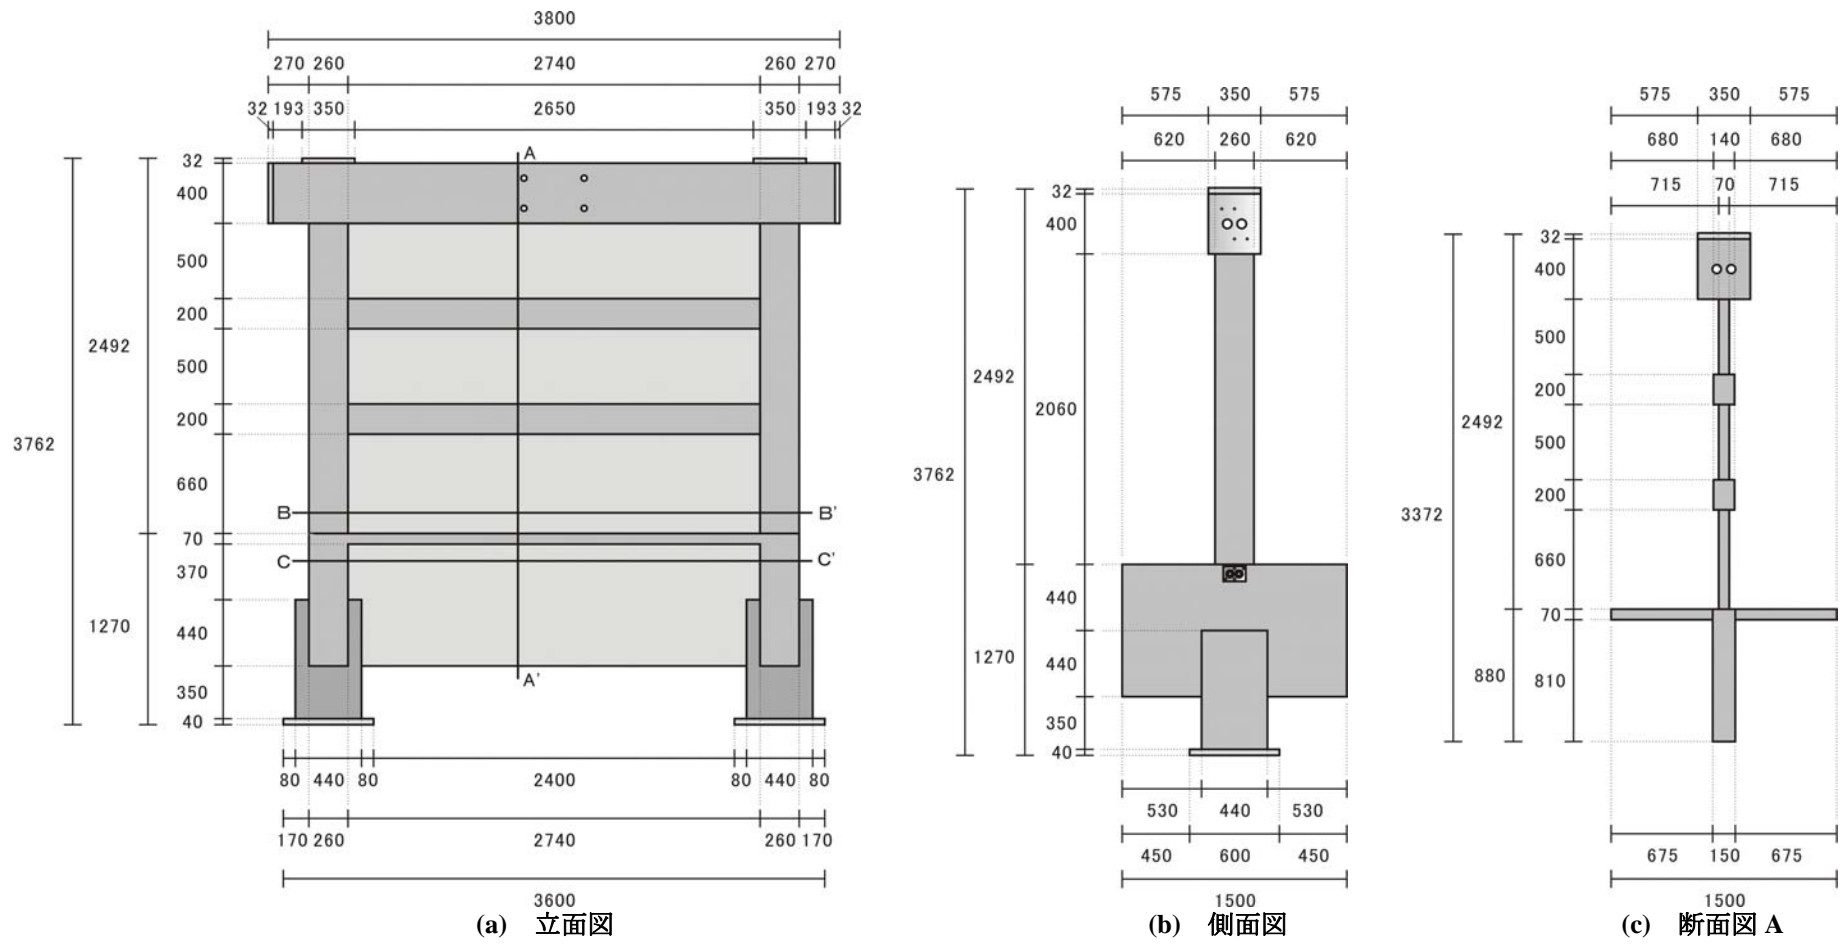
MNWL 試験体の寸法 1 (単位 : mm)
